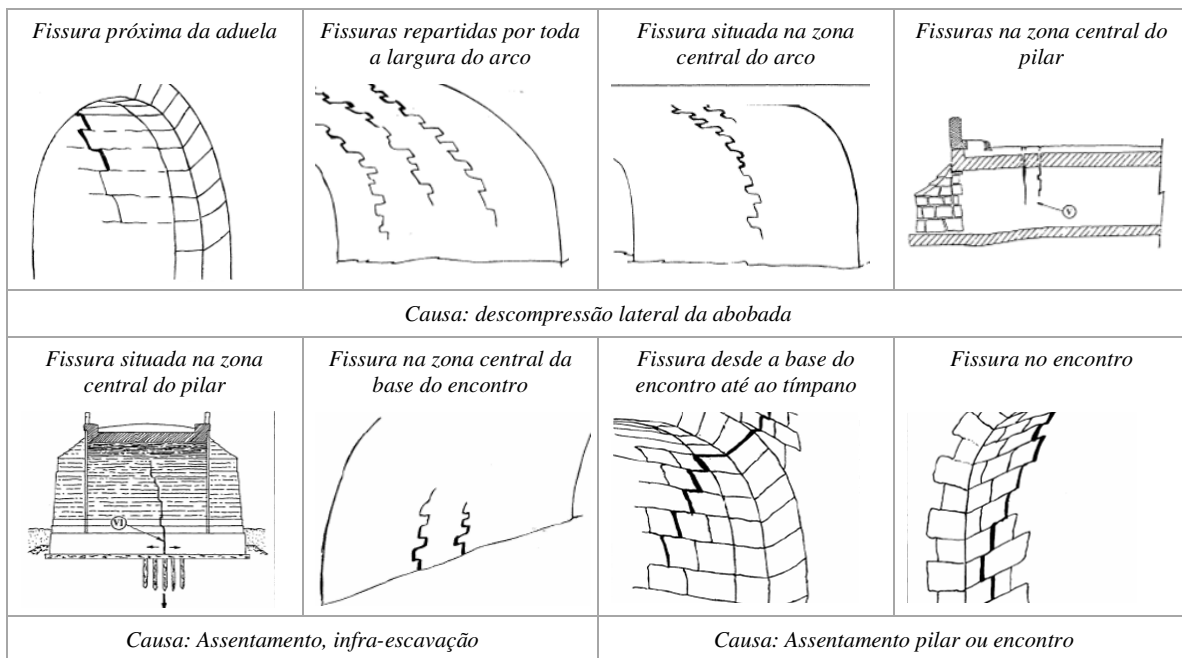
Tipos de fissuras longitudinais e possíveis causas (IQOA 1996)
